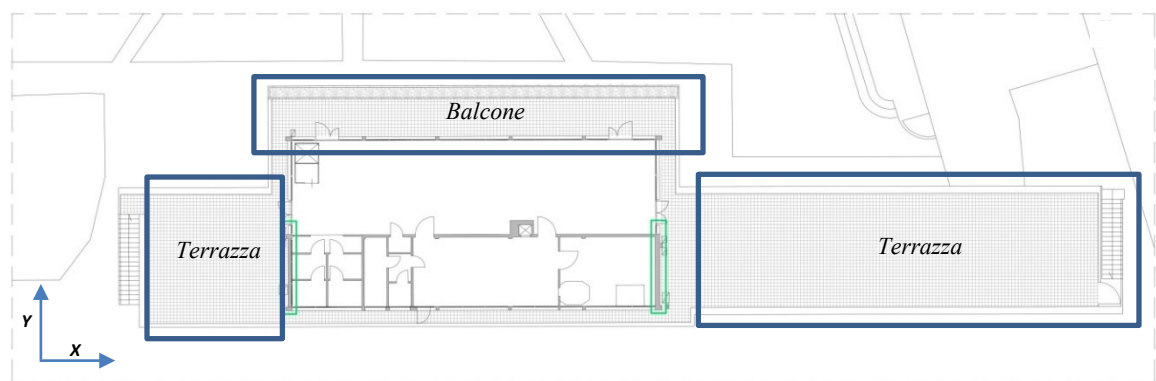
Pianta del primo piano con localizzazione delle due terrazze laterali e del balcone centrale
